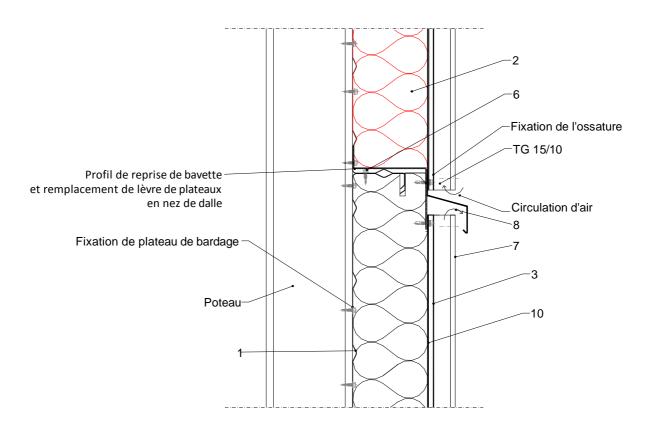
Fractionnement de lame d'air – Coupe verticale
